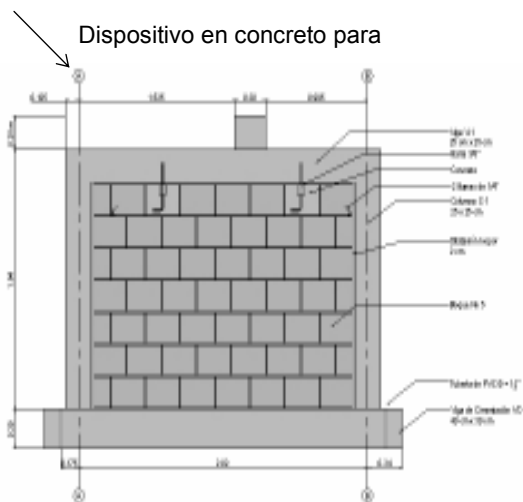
Geometría general del modelo (m) para ensayo en el plano del muro aislado. Adaptada de UNIANDES-CITEC, 2004
